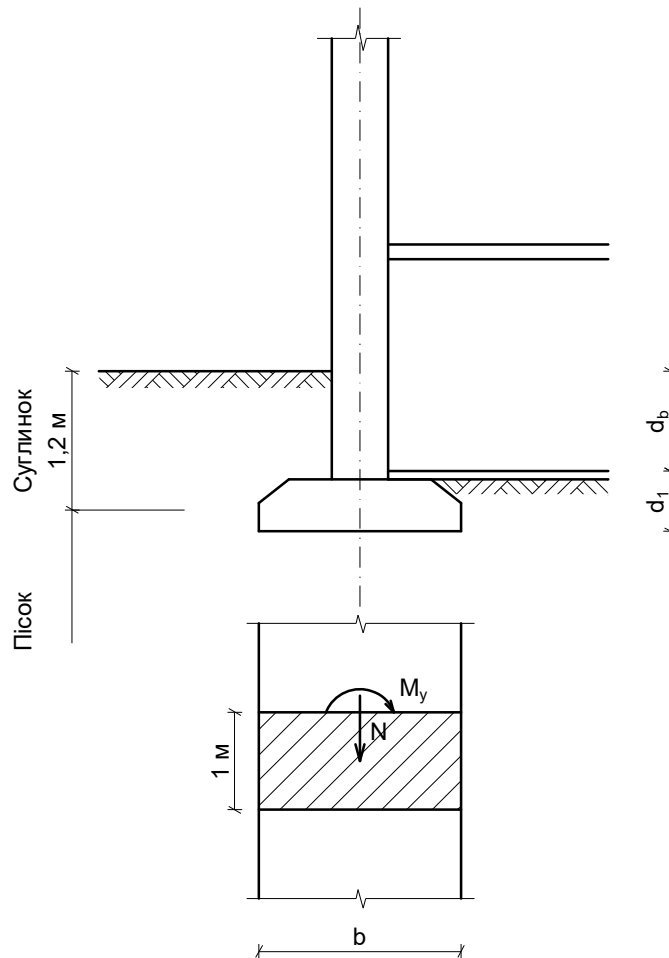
Схема розміщення стрічкового фундаменту у ґрунті
